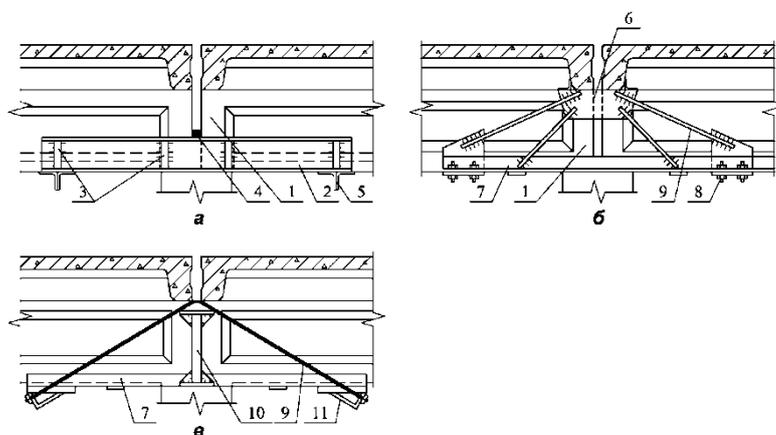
Усиление конструкций дополнительными упругими опорами в виде двух консольных кронштейнов: а – из прокатных профилей; б, в – из треугольных ферм
